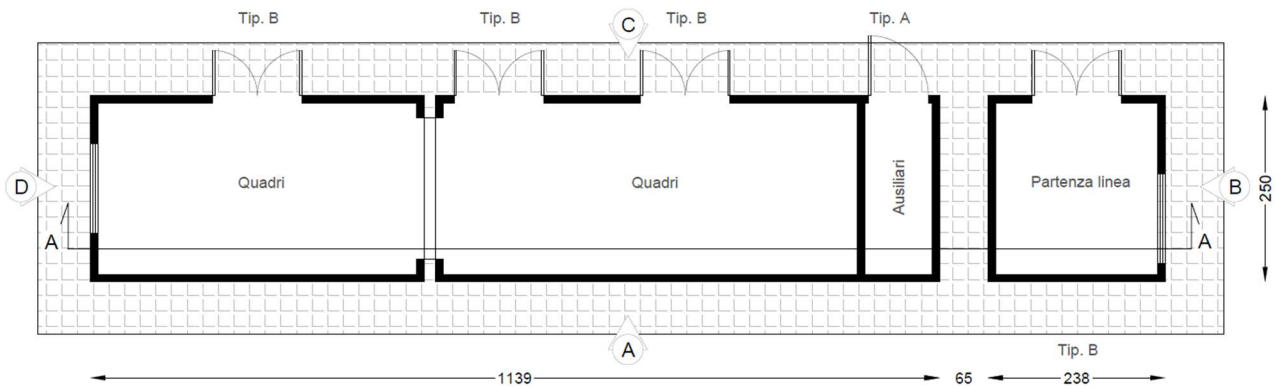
Planimetria generale della cabina MTR di raccordo e connessione- tutte le misure in cm
